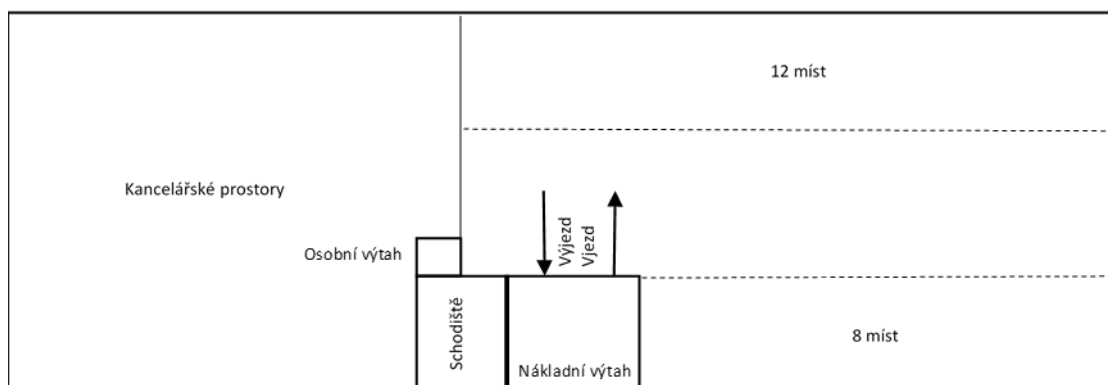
Schéma půdorysu 1. a 2. nadzemního podlaží parkovacího domu
